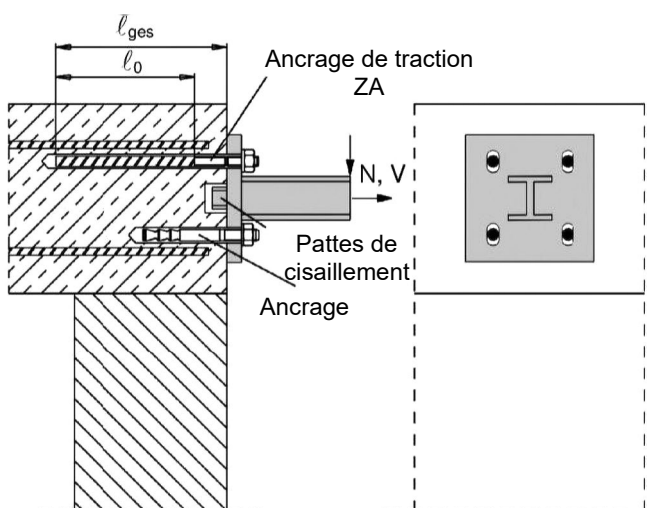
Joint de recouvrement pour l'ancrage d'un élément en porte à faux
